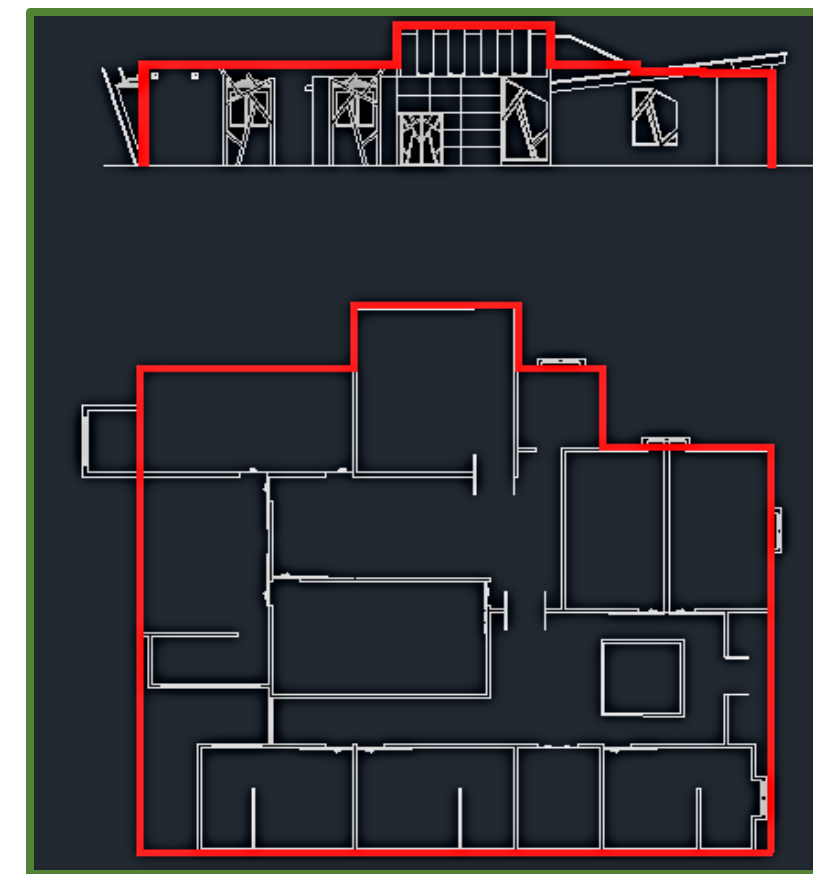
Estudio de proporción de planta con el alzado en el edificio de administración.
